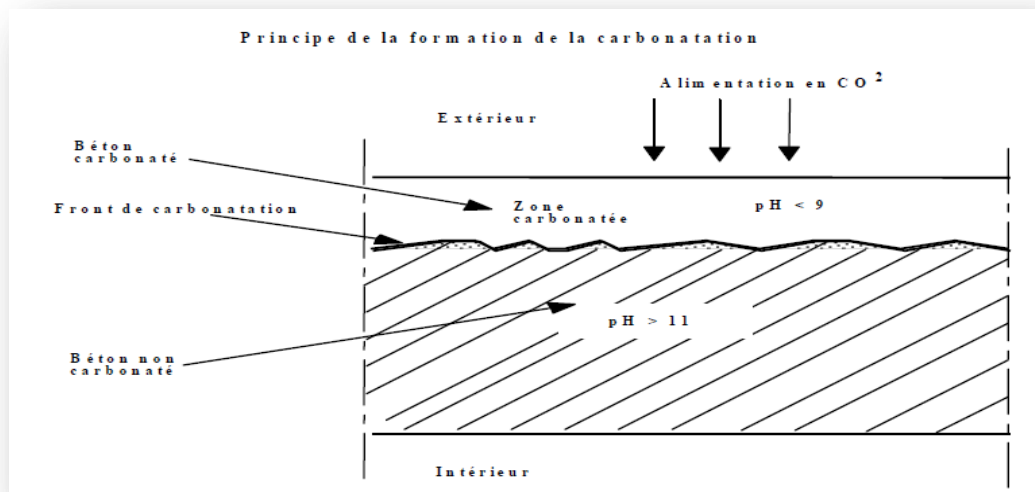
Coupe théorique d'un mur en béton. [46]
